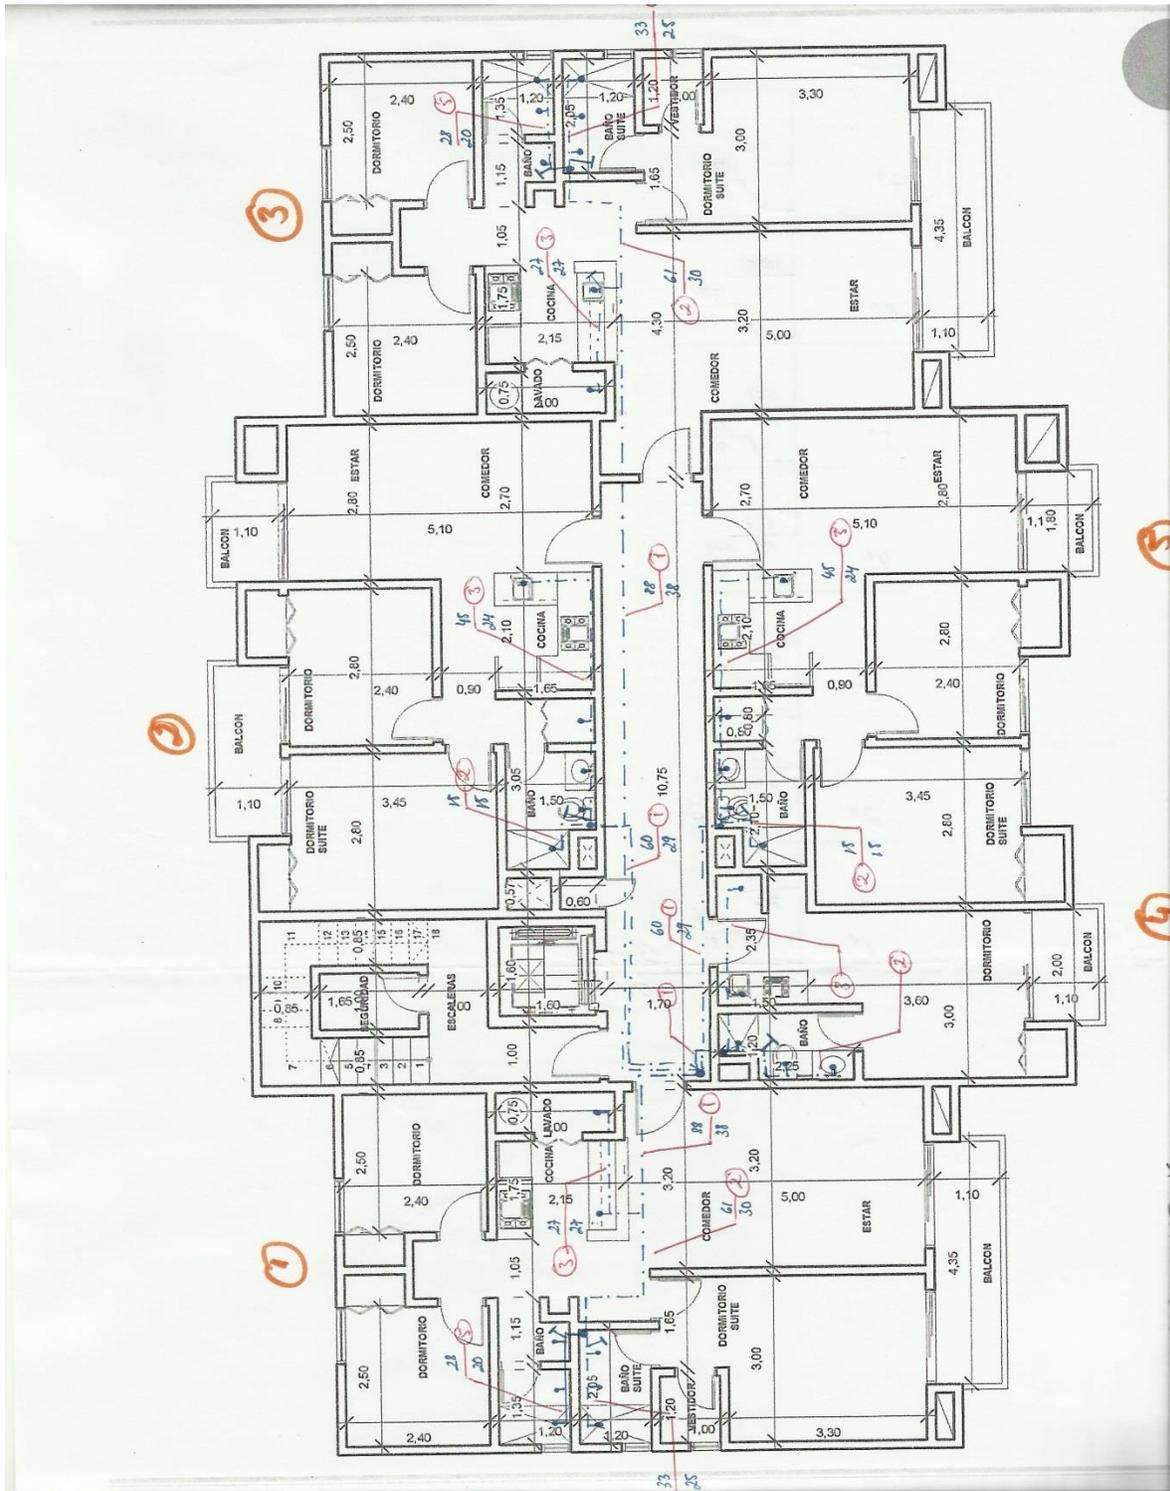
Plano Instalación Hidráulica Piso 2 al 6
